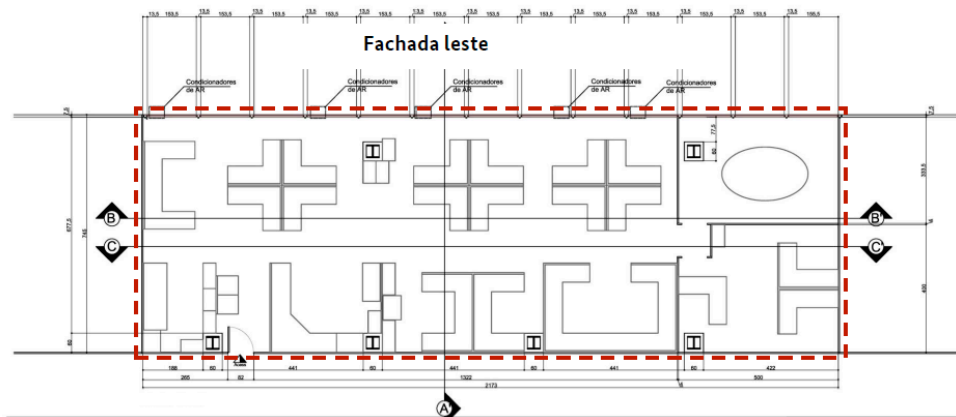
Pavimento tipo do Bloco "C". Levantamento pelos autores e equipe da TUM.
